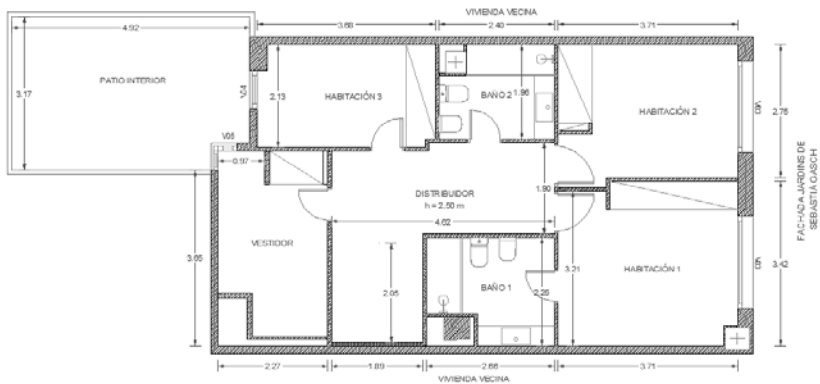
Plano estado actual Planta Primera. Fuente propia
